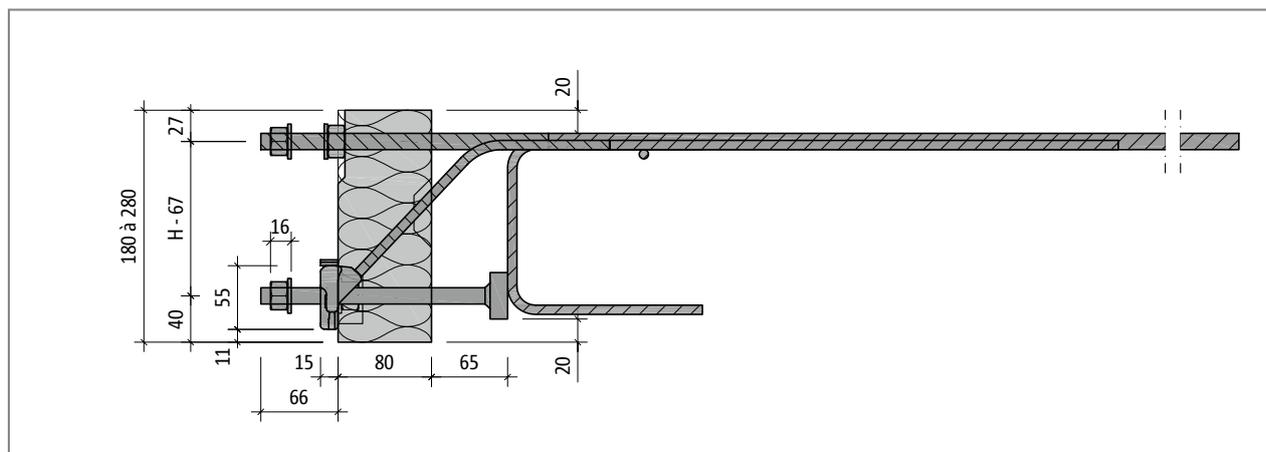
Schöck Isokorb® T type SK-M1-V1 : coupe du produit
